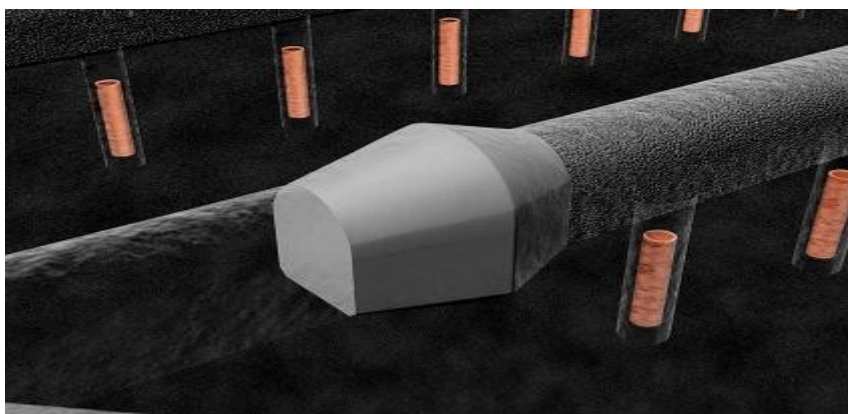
Betonová tunelová zátka ropné kaverny [2]
